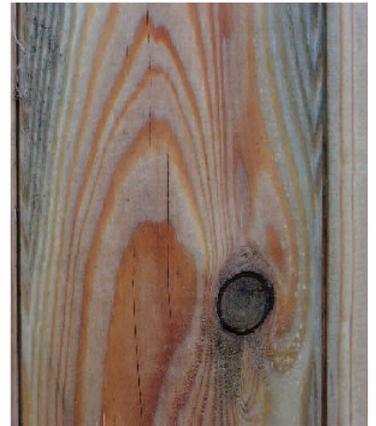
Detailansicht, das Splintholz wird intensiver durch Bläue- und Schimmelpilze bewachsen als das dunklere Kernholz.
